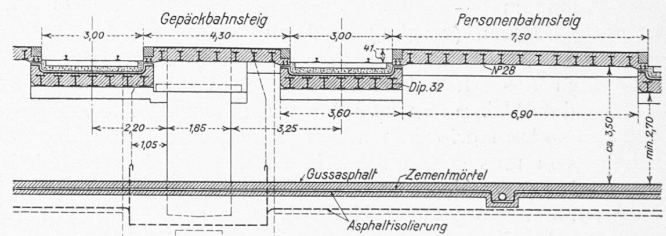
Längsschnitt durch den Posttunnel. — 1 : 200.
